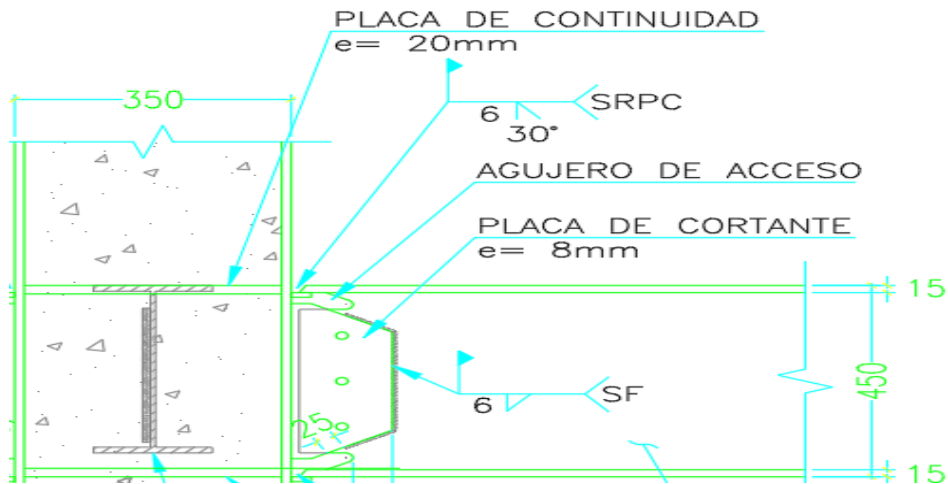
diseño óptimo de agujeros de acceso para soldadura
